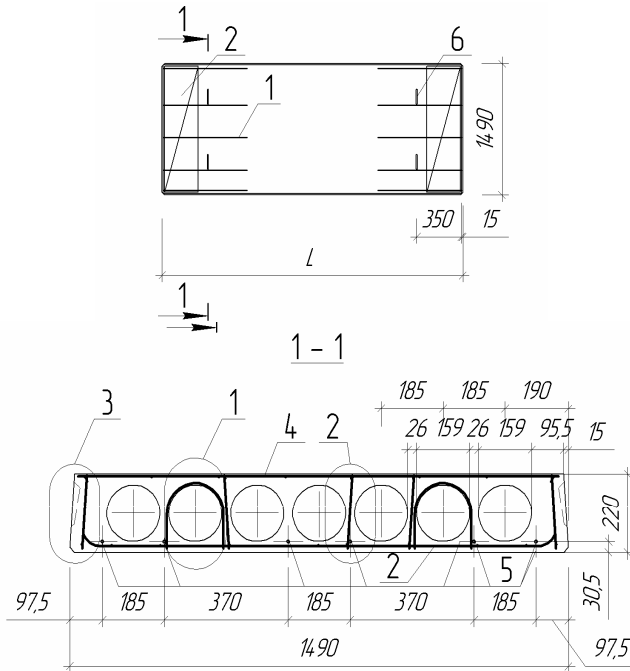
Конструкция пустотной панели: 1 – каркасы с поперечной арматурой в ребрах панели; 2 – сетки косвенного армирования, усиления зон передачи усилия предварительного напряжения; 4 – конструктивная сетка армирования верхней полки; 5 – продольная предварительно напряженная рабочая арматура; 6 – строповочная петля
